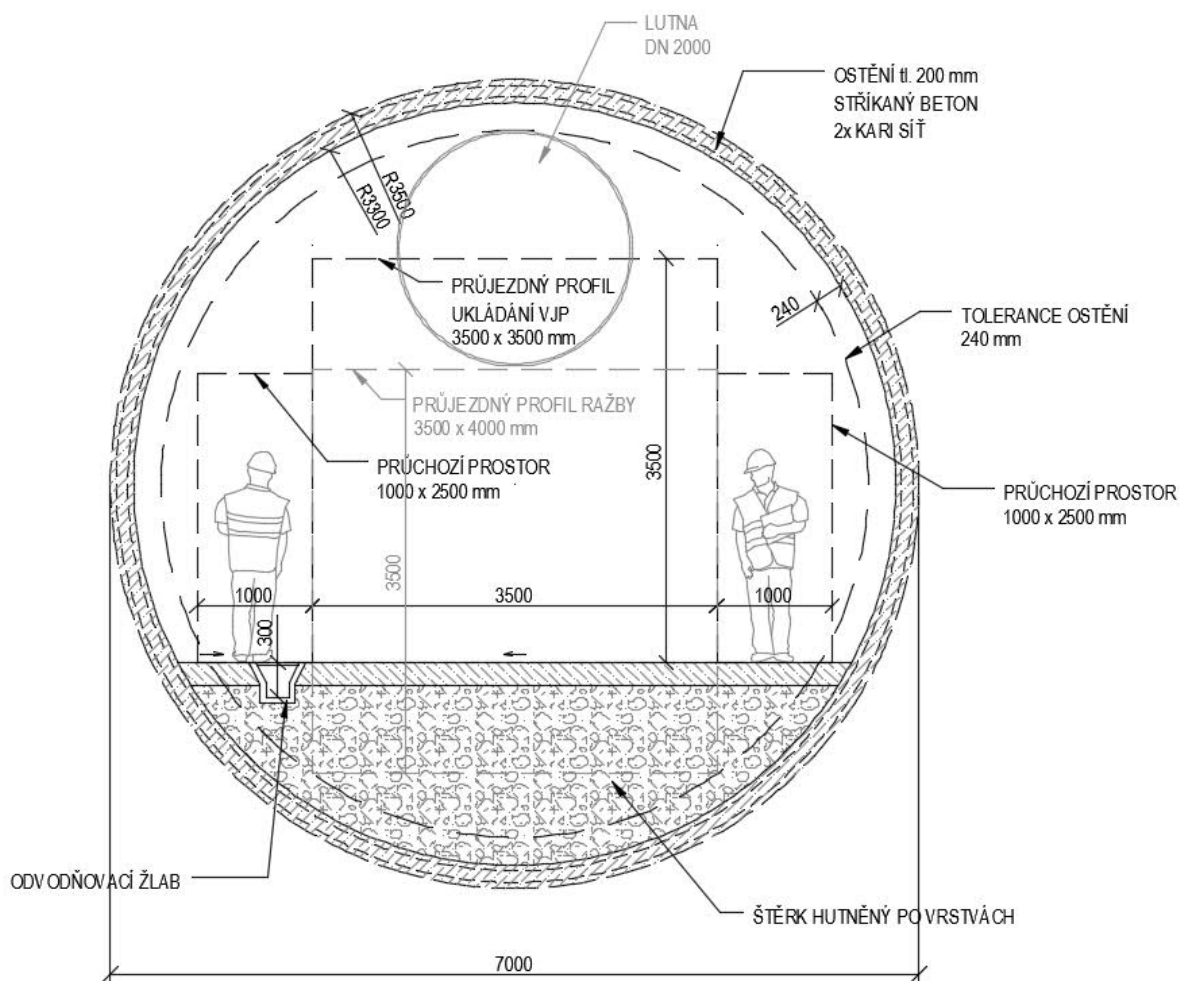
představuje příčný řez zavázcím tunelem při použití ražby TBM u vertikálního způsobu ukládání – varianta D1. V obrázku je použito stříkaného betonu pro primární ostění tunelu. U horizontálního ukládání jsou požadavky na průjezdný prostor manipulačních prostředků s UOS na ukládacím horizontu VJP oproti požadavkům v zavázcím chodbě rozdílné. V případě využití plnoprofilových razicích strojů je ovšem optimální volit pro ražbu úpadního tunelu a páteřních chodeb jednotný průřez.
